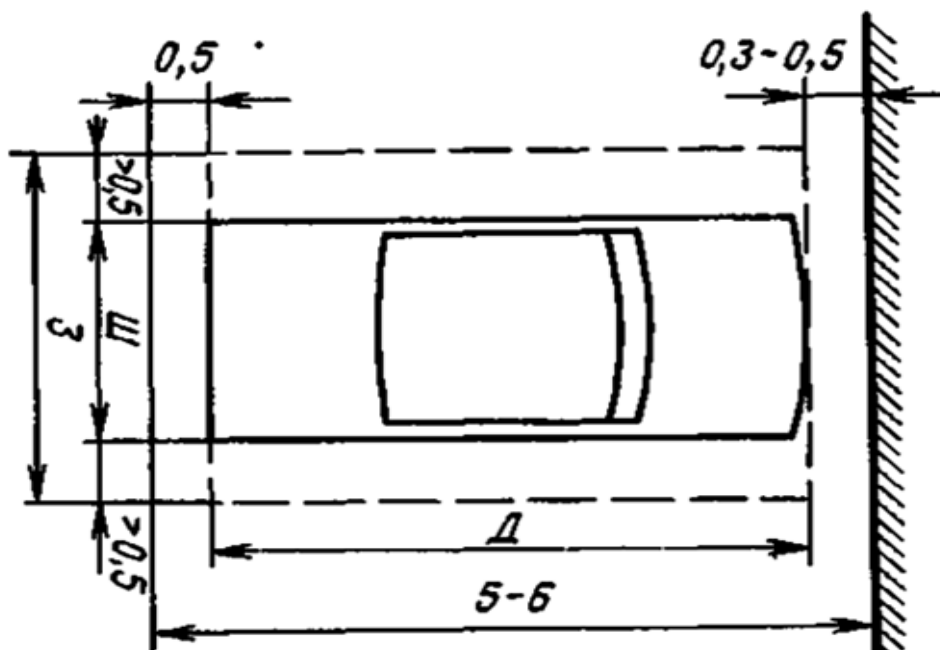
Размеры (м) ячейки для хранения автомобиля на стоянках: Д и Ш - габаритные длина и ширина расчетного автомобиля.
